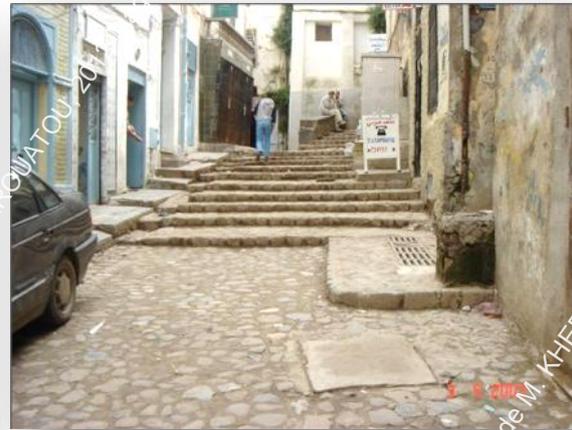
Revêtement de la rue Saïd Bentchikou en pierres de rivière. Source (Boufenara, 2008)
